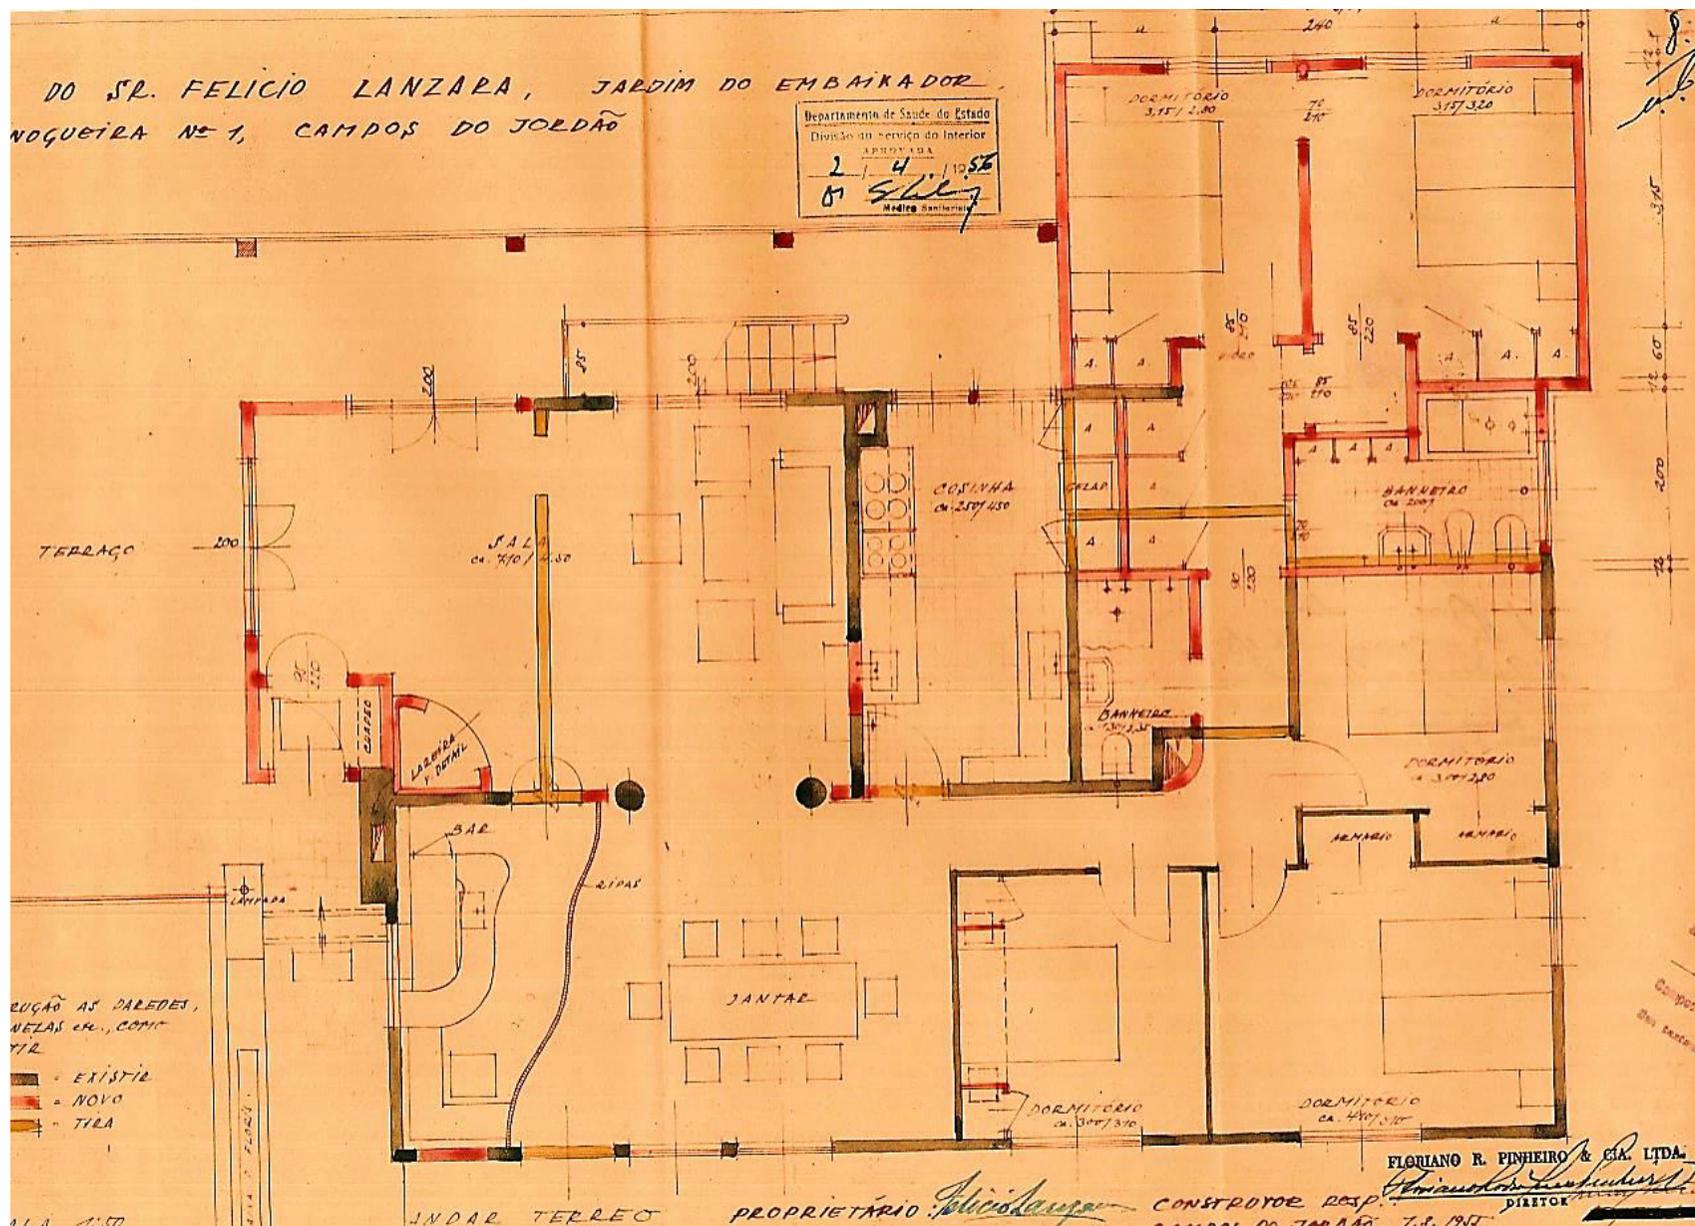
Planta da reforma na Casa Adhemar de Campos/Felício Lanzara, 1955.
